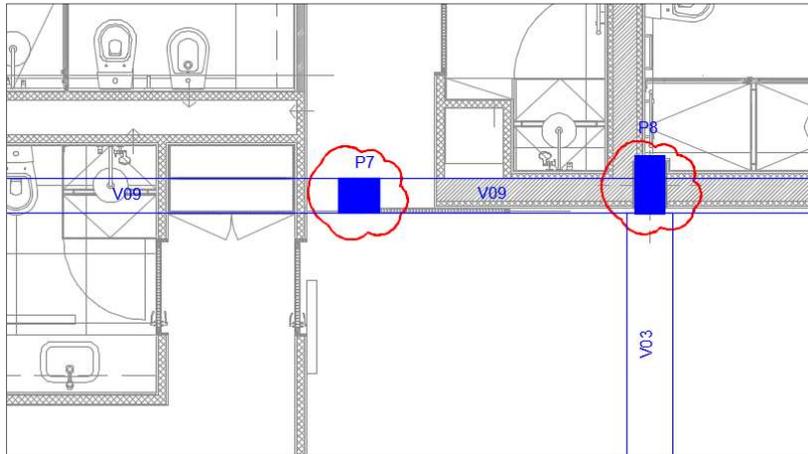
Sobreposição entre projetos de Estrutura e Arquitetura
